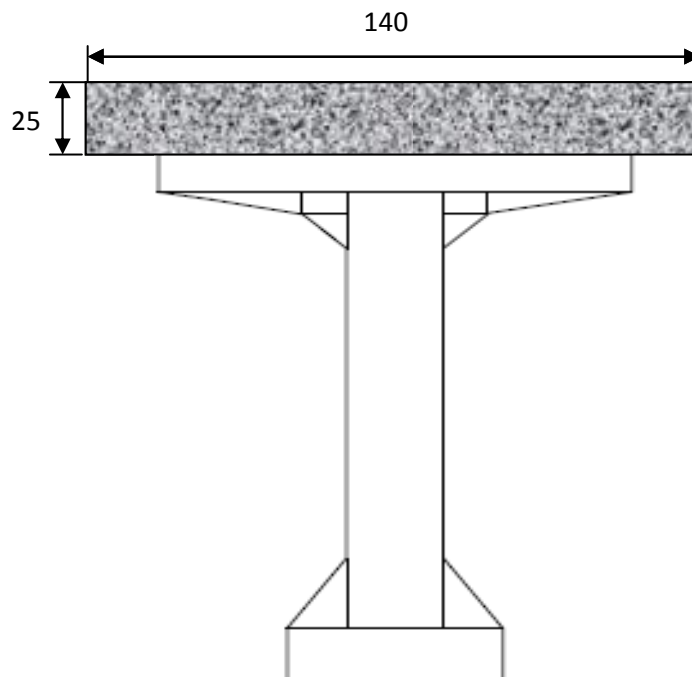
La section médiane de la poutre en BP plus l'hourdis général.
